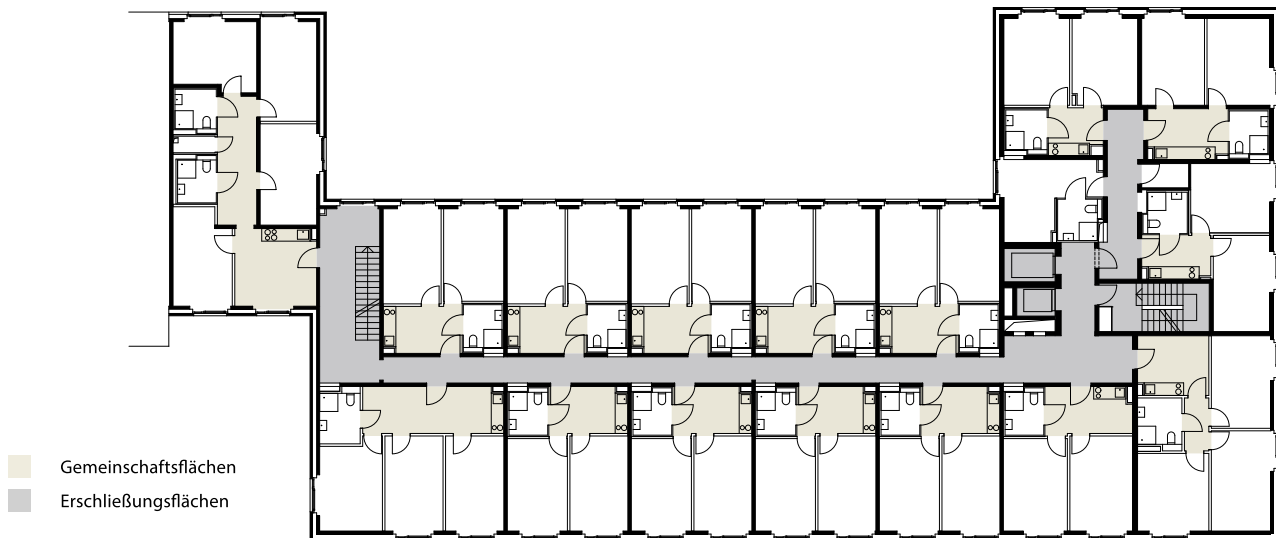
Grundriss Regelgeschoss, M. 1:375 [© BF Vario]
